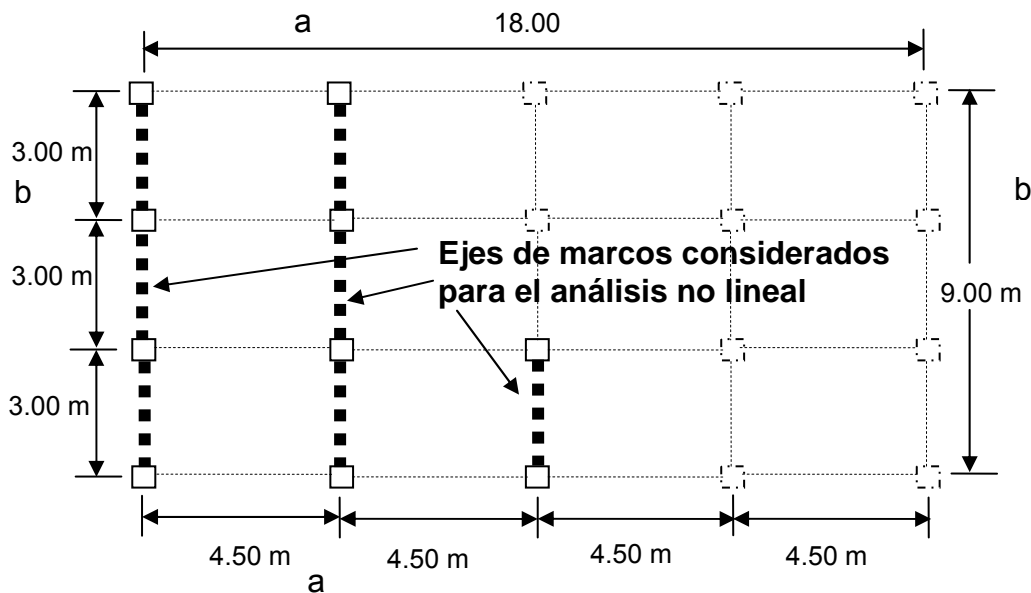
Se muestran los marcos empleados para construir la estructura plana de 7 niveles que se trabaja con el SIMESTRU y el DRAIN 2.
